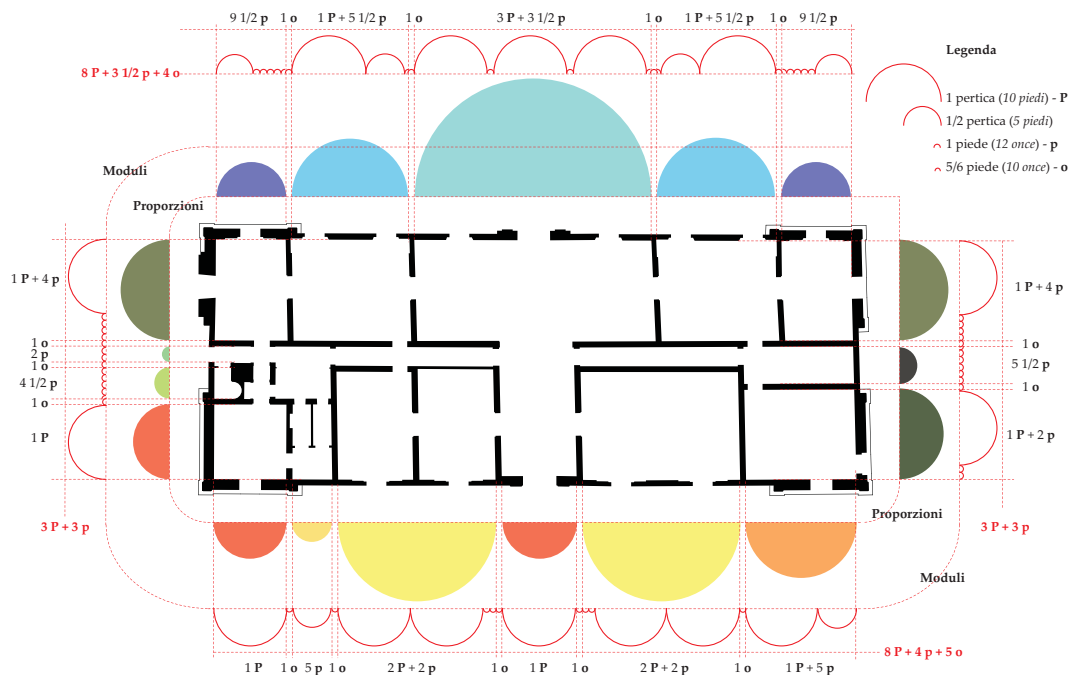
Analisi sulle euristiche modulari e le corrispondenze rilette attraverso l'unità di misura del tempo, calcolate rispetto agli spazi interni della sezione planimetrica del piano terra.
